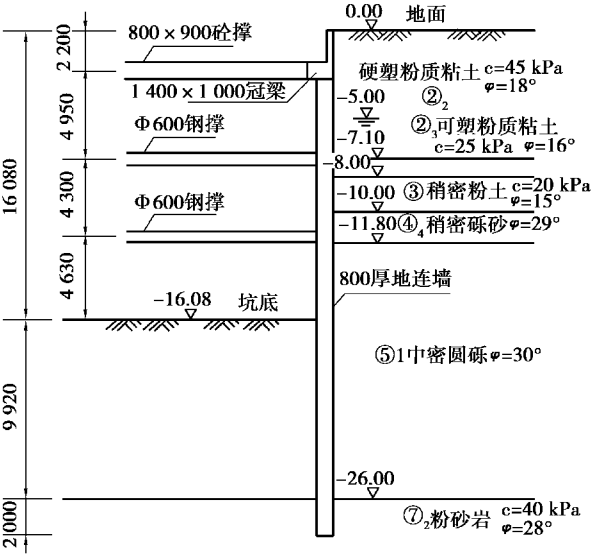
广西大学站标准段基坑剖面图(单位:mm)
